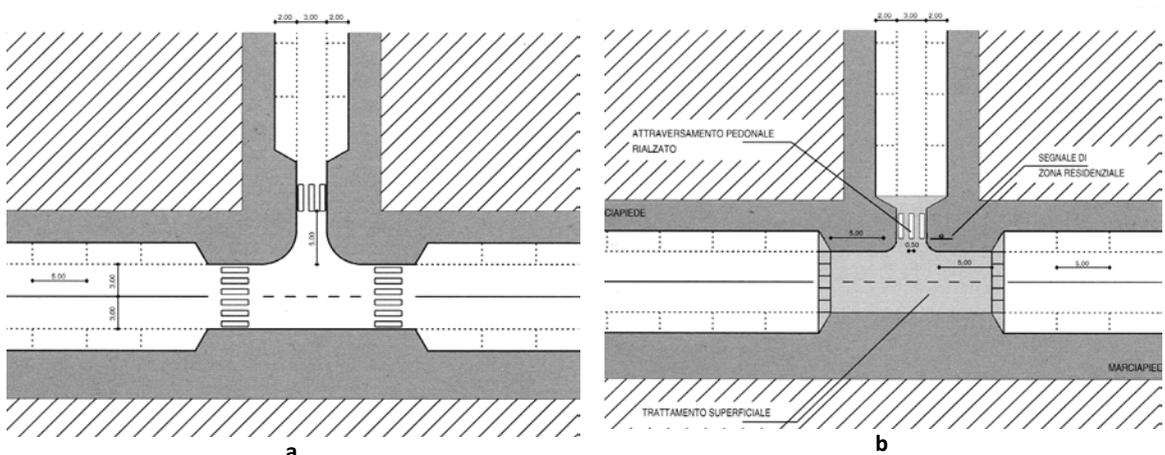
Zona a porta con restringimento (a) e con platea rialzata all'intersezione (b)
